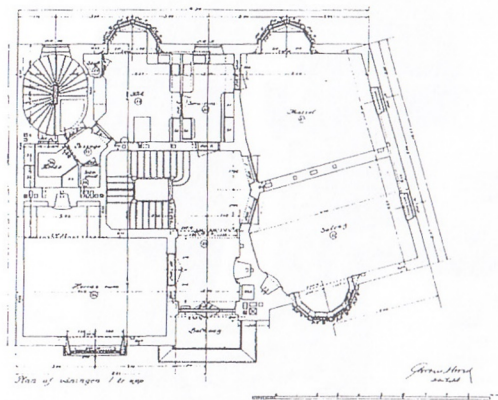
Runo Abrahamsons hus, plan våning 1 trappa.
